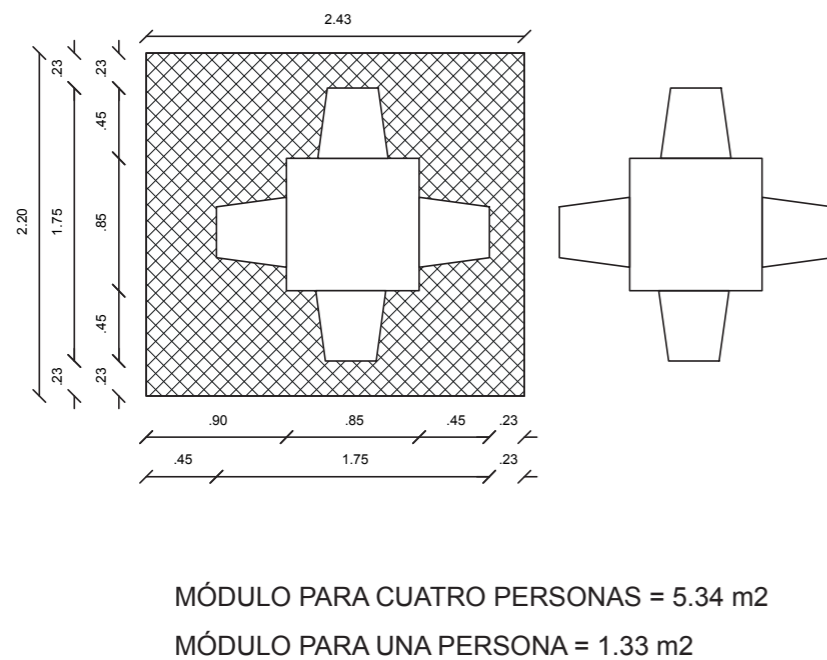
Planta módulo mesa cafetería para cuatro personas.
